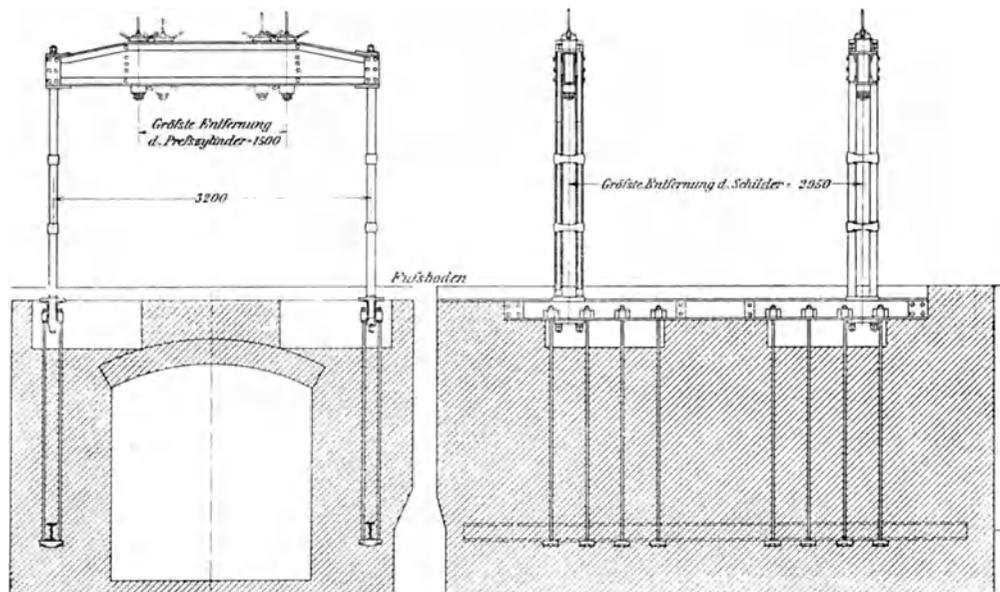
Maschine zur Deckenprüfung von Martens. A. Borsig-Tegel.
